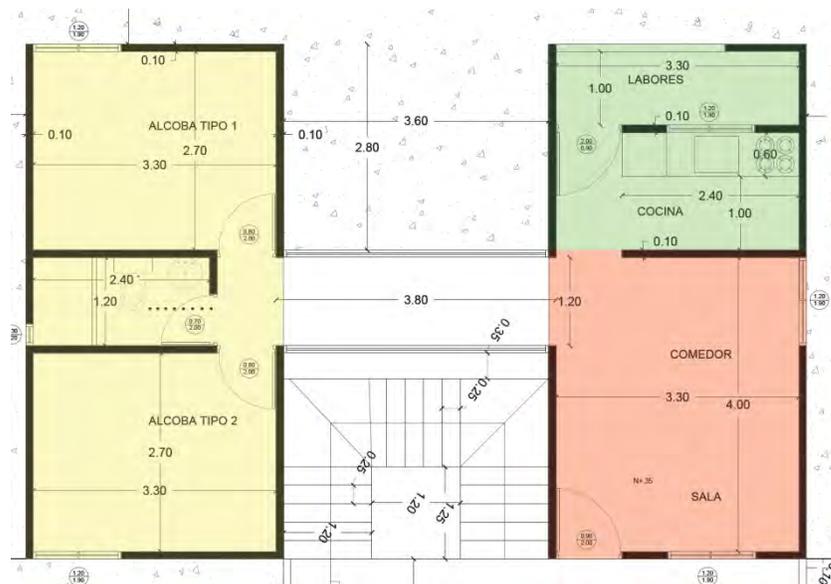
Plano propuesta prototipo FUENTE: Arq. Carlos A. Rengifo E.
